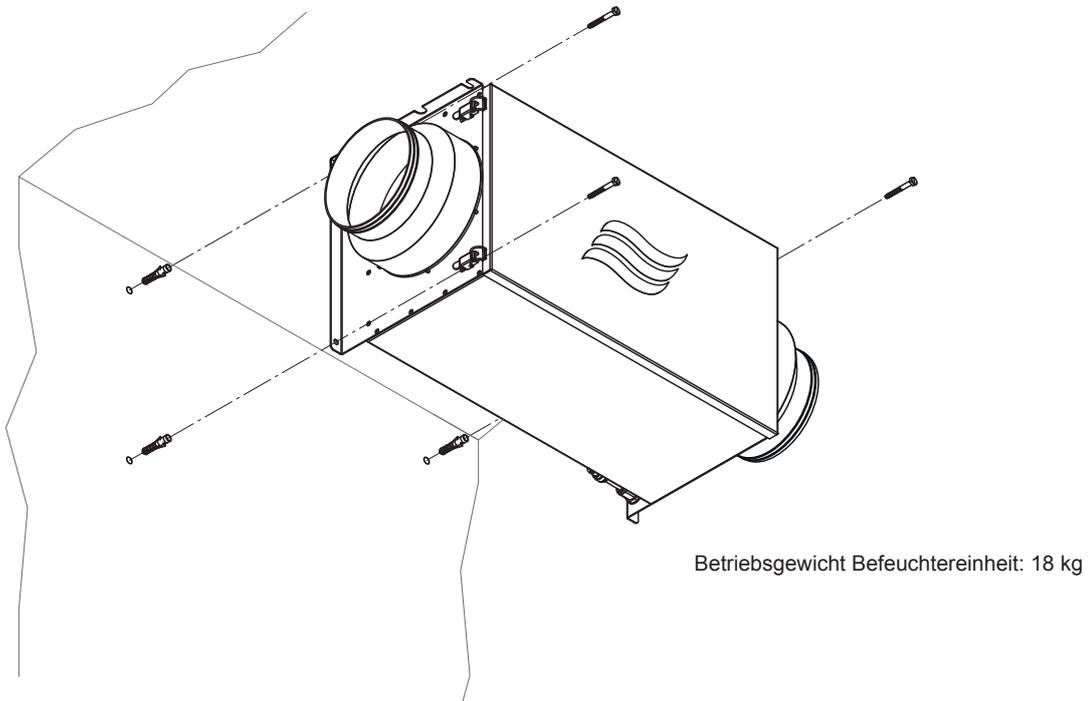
Befeuchtergehäuse an der Wand befestigen
